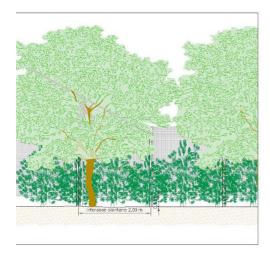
Prospetto recinzione perimetrale con mitigazione
